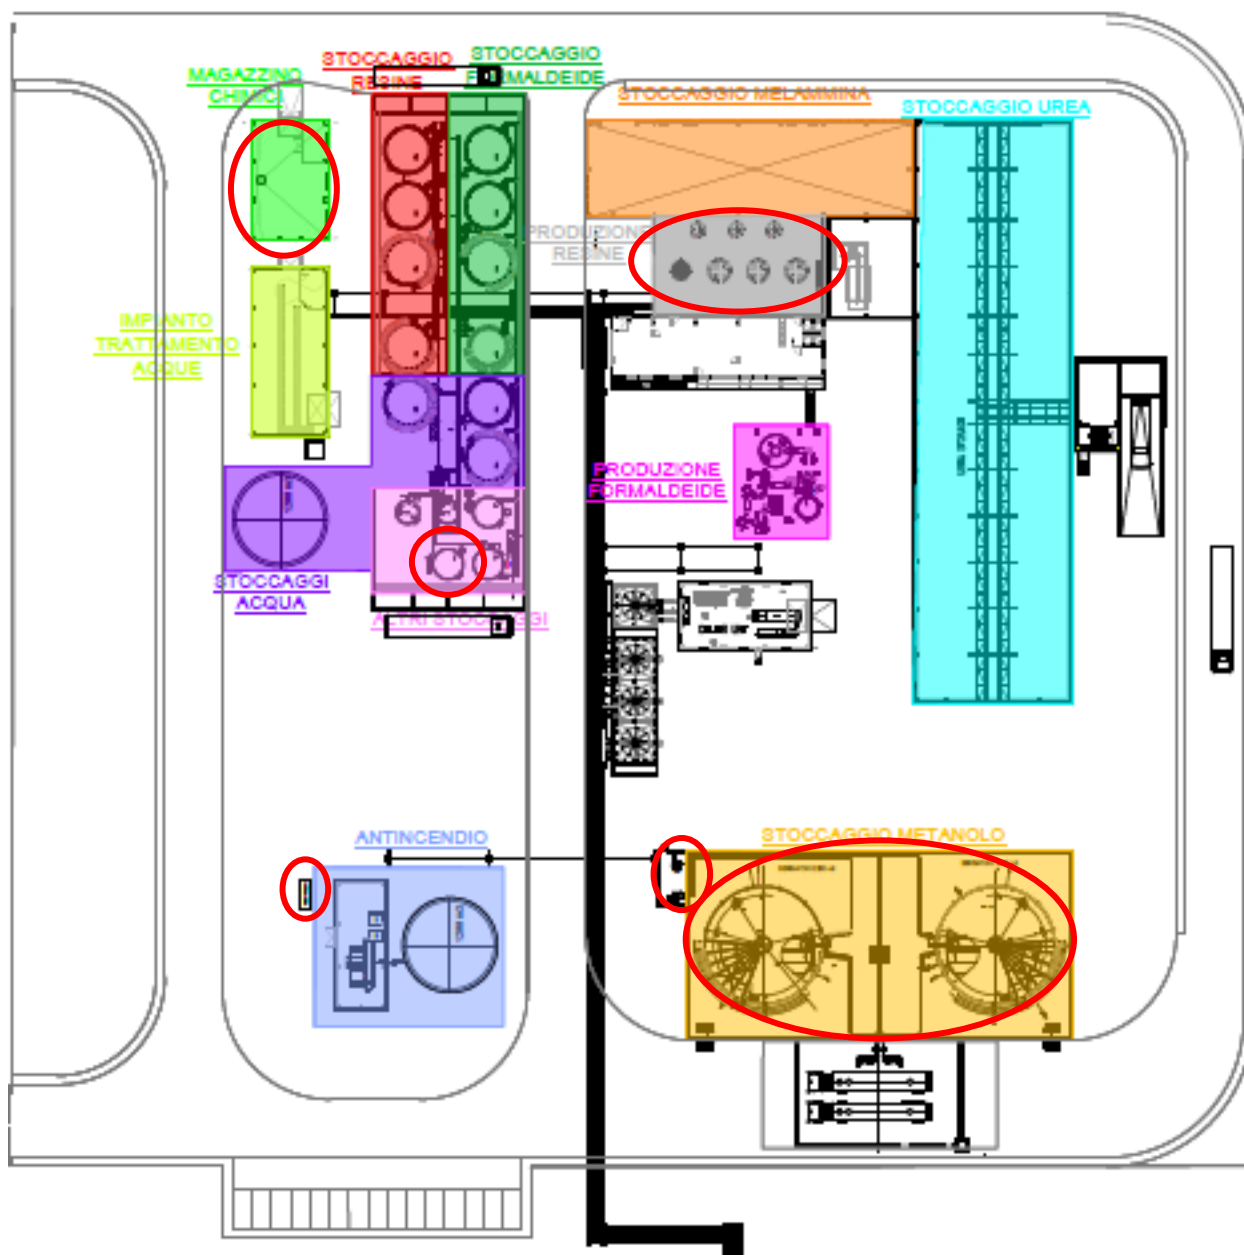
Planimetria impianto con indicazione aree di stoccaggio sostanze pericolose
